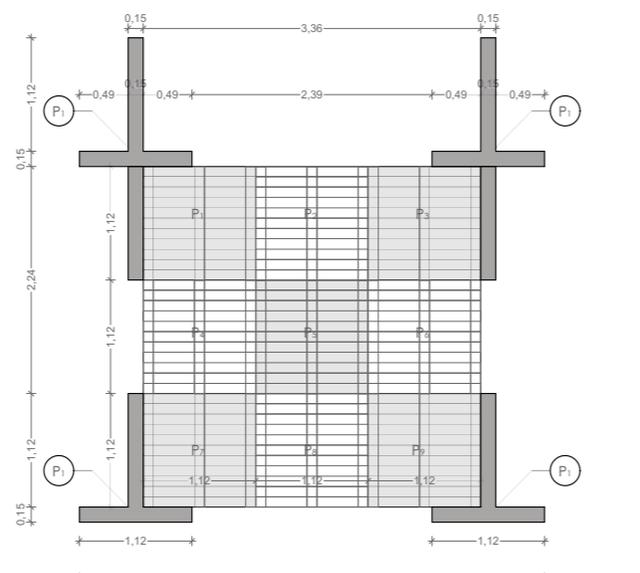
PLANTA DE LA UNIDAD HABITABLE
